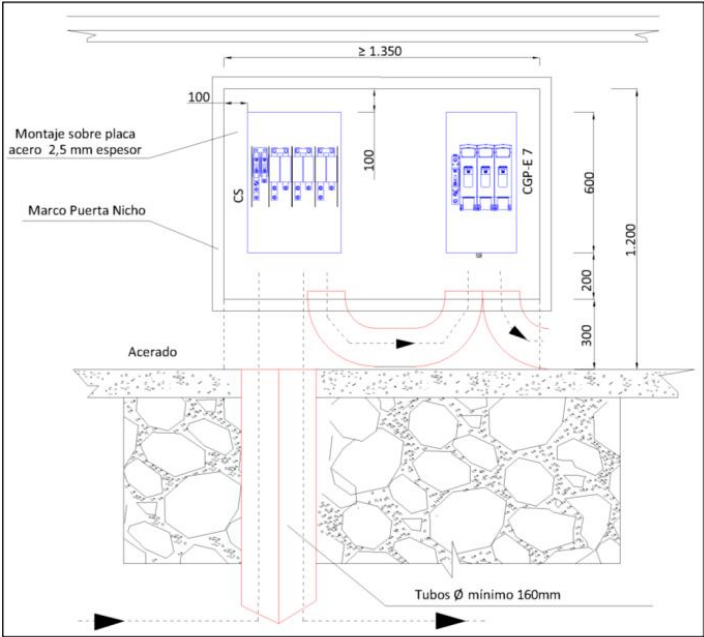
Instalación CGP y CS montaje horizontal. Alzado.
